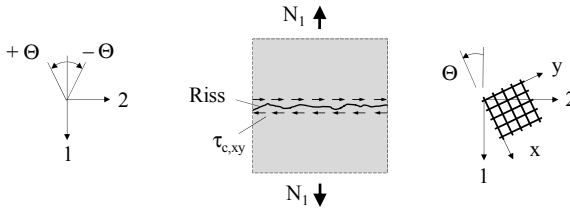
Beanspruchung im Riss $\tau_{c,xy}$ für Θ positiv, Situation bei schiefwinkliger und orthogonaler Bewehrung unter einaxialem Zug
